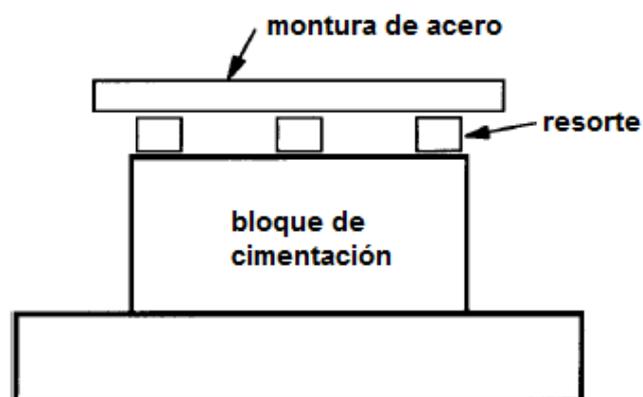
Cimentación bloque con equipo asentado en resortes. Fuente: ACI
